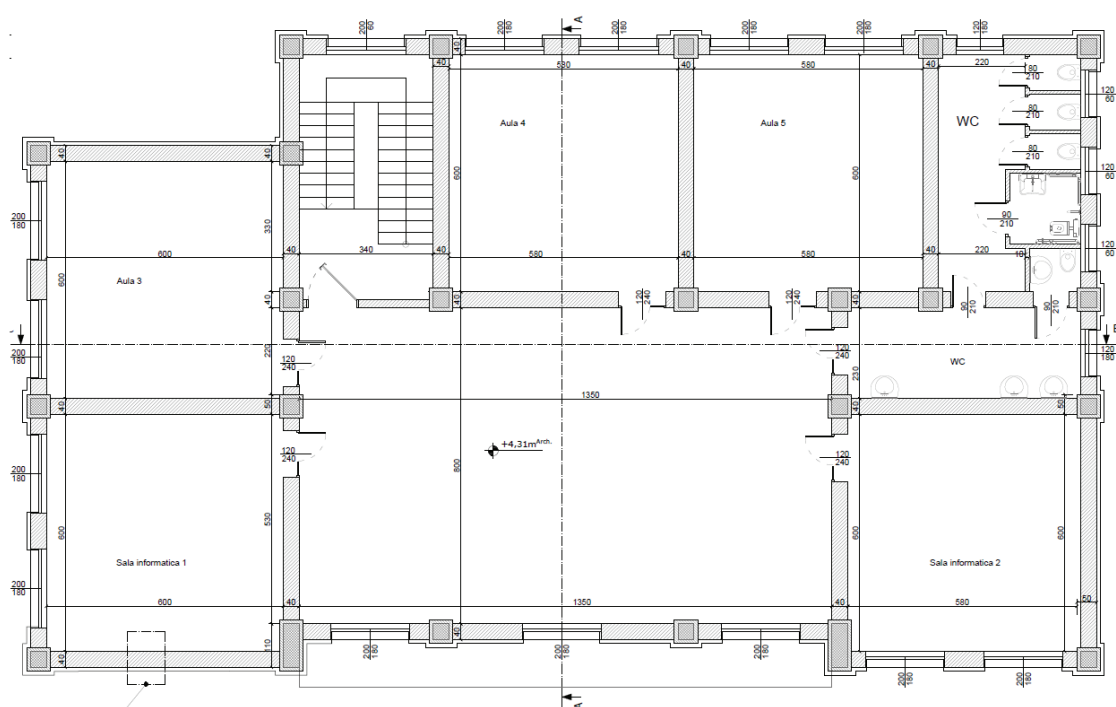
Pianta Piano Primo- Stato Futuro
